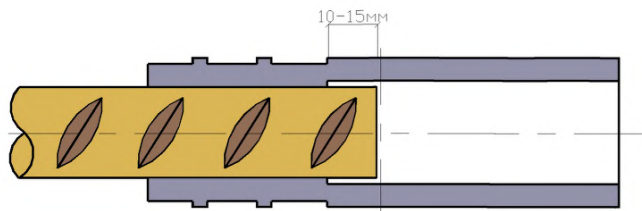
Опрессованный стык, обжатый с одной стороны
